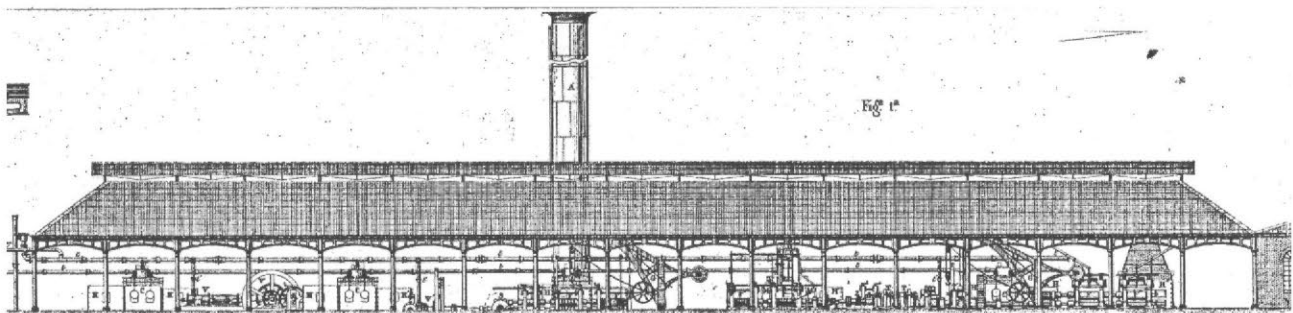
Vista longitudinal del taller de fabricación de hierro forjado.
